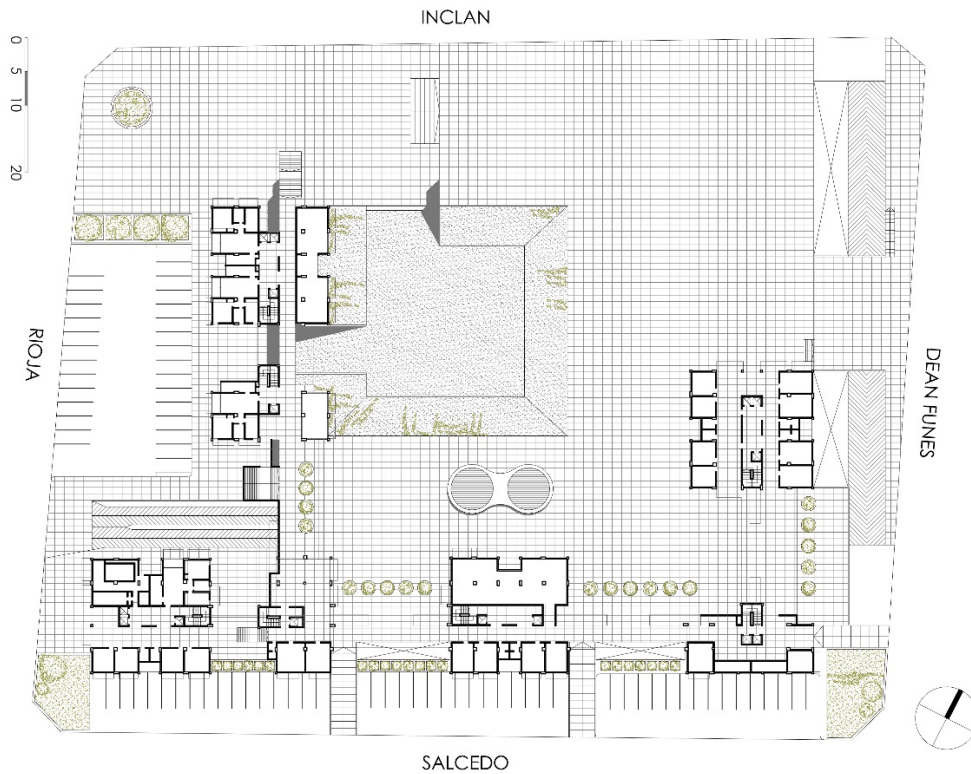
Conjunto Rioja. Planta general a nivel de la plataforma en planta baja. Elaboración del autor.
